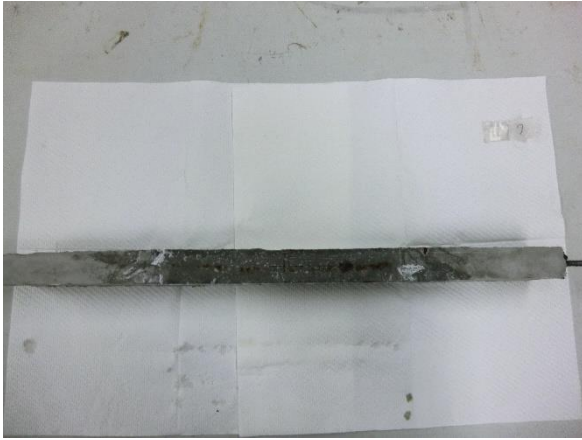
No.VIIの腐食ひび割れの様子
